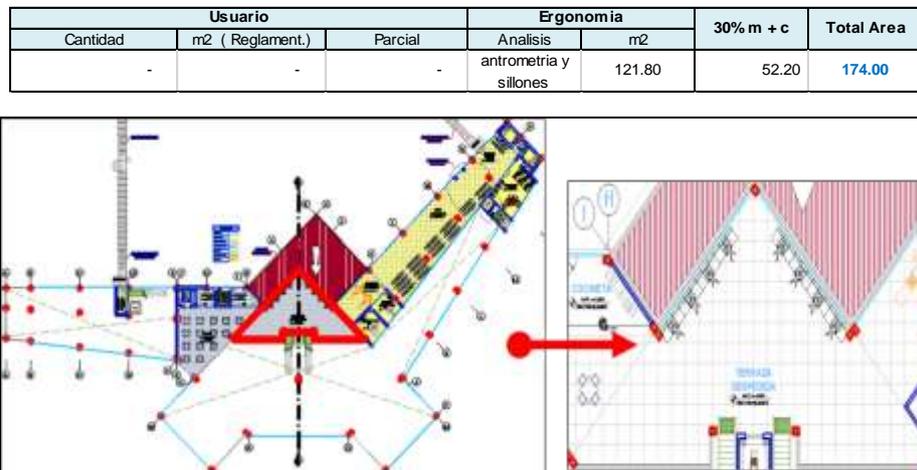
Terraza de despedida; fuente: Plano Z. Módulos 1° nivel A-01
